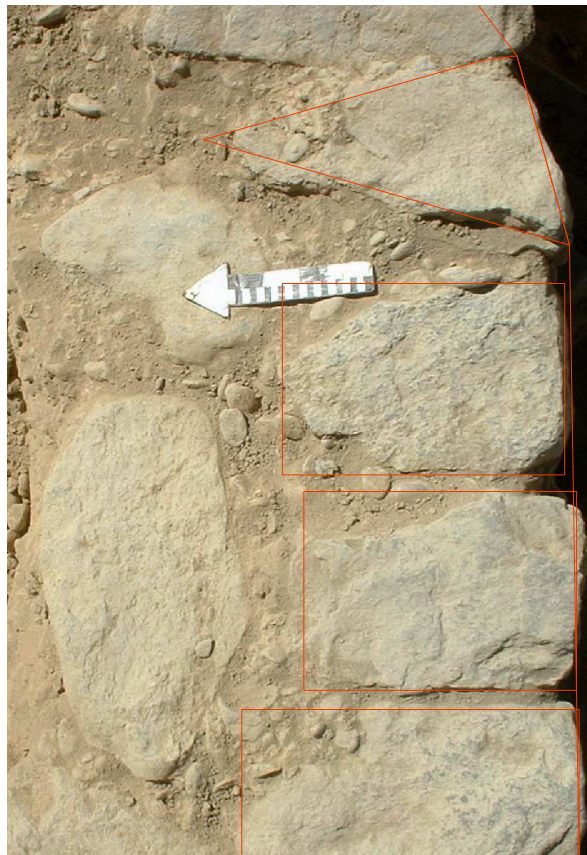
Detaillierte Lage von quaderförmigen und flachdreieckigen Steinen in der Mauer M-67 zur Erzeugung des fünfeckigen Grundrisses der Außenmauer, mit Lehm- und Flusskiesfüllung
